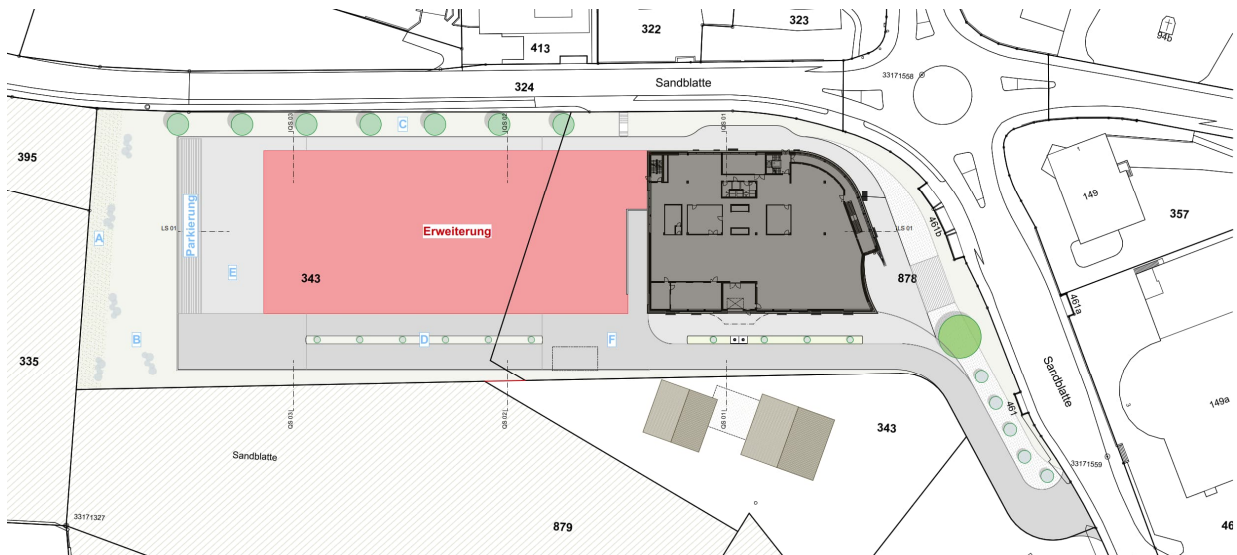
Situationsplan Erweiterungsbau und Umgebungskonzept (BF architekten)
